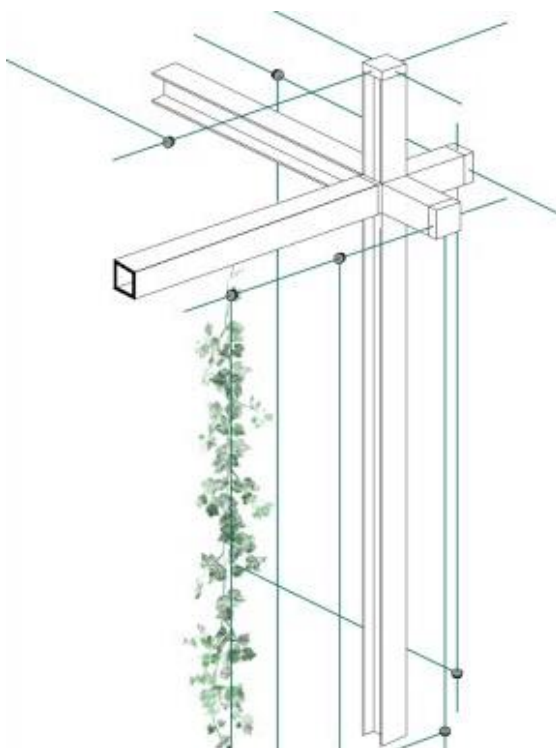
Pormenor de construção do sistema de suporte, Parque MFO (<https://urbannext.net/mfo-park/>; acedido a 05/2019)
